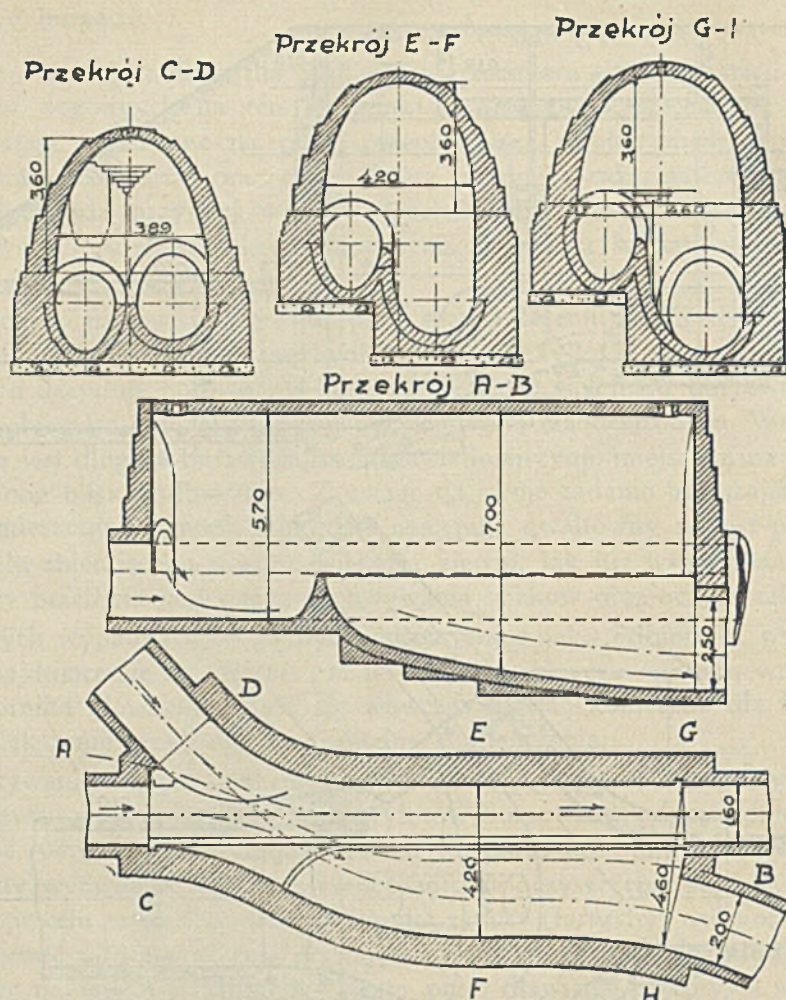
Przelew burzowy przed oczyszczalnią ścieków w Otwocku.
